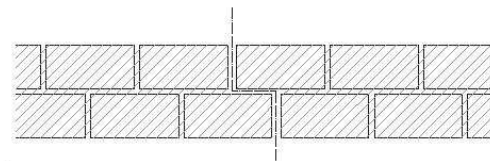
Junta de movimiento con solape. Esquema en planta
